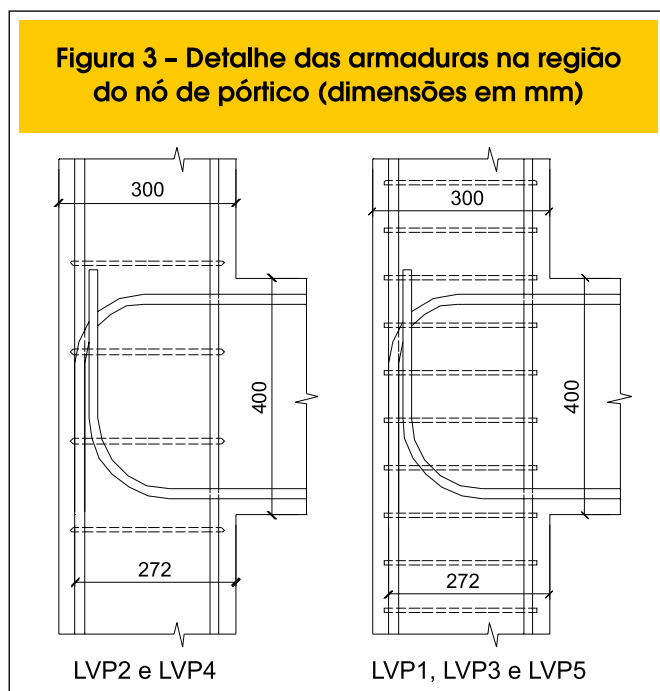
Detalhe das armaduras na região do nó de pórtico (dimensões em mm)
